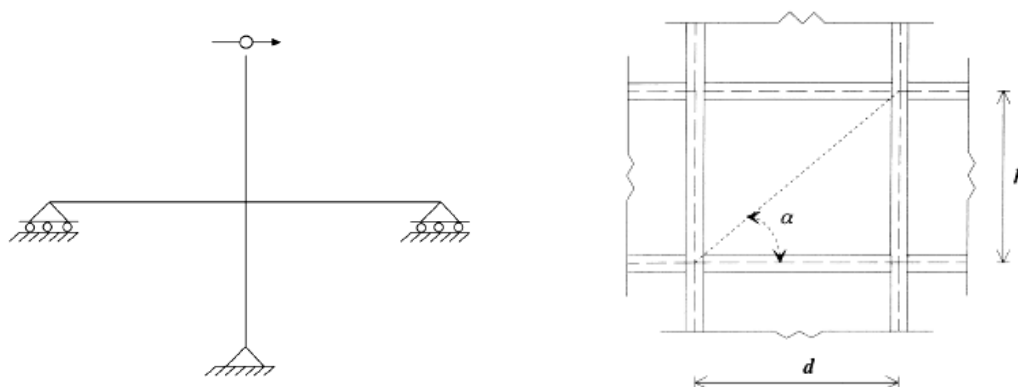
4 Assemblaggio trave-pilastro e zona di pannello.
